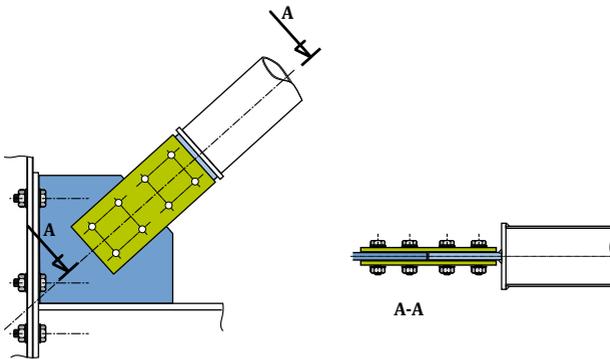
Assemblage par simple plat et couvre-joints pour une diagonale à section creuse circulaire
